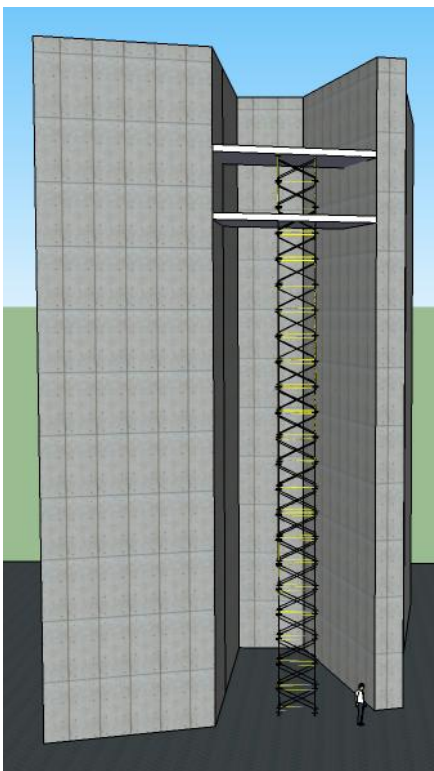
montaje de elementos de 6to. Y 7mo. Piso.
